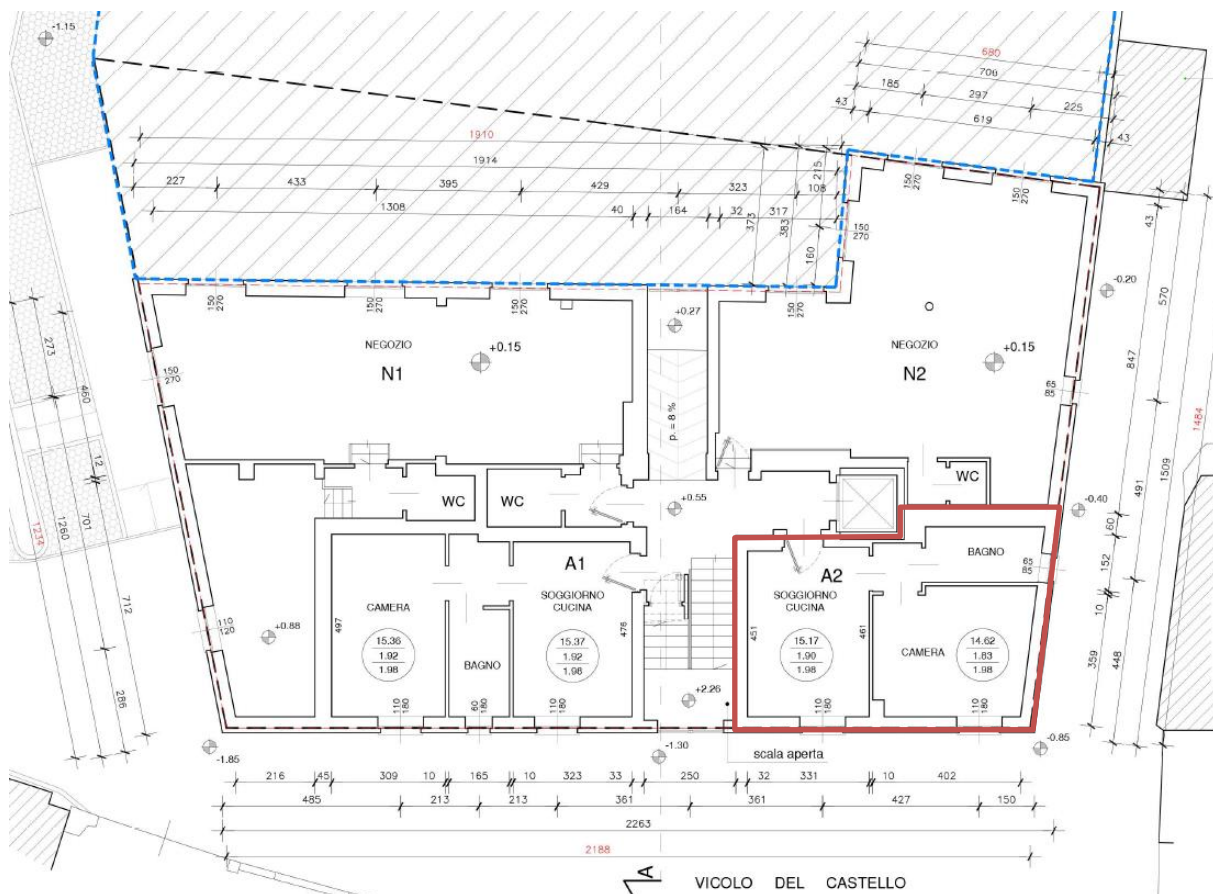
ESTRATTO PIANTA PIANO TERRENO SCIA N. 5709 DEL 2019
